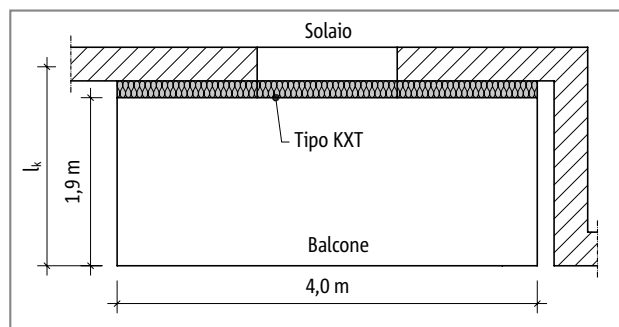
Schöck Isokorb® tipo KXT: pianta
